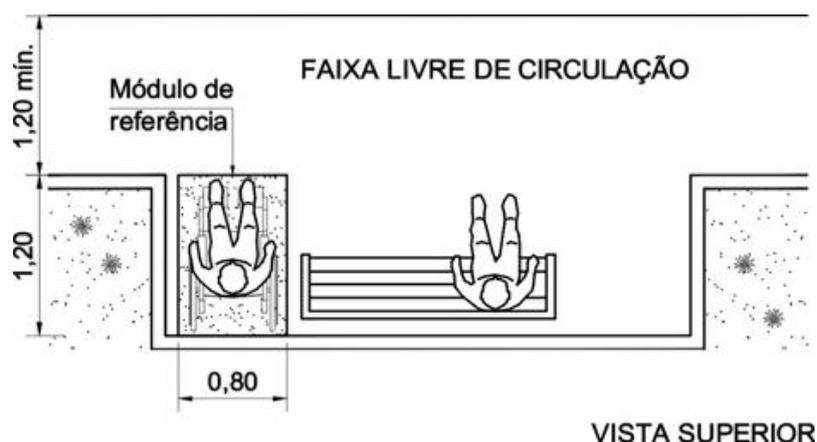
Vista superior de um assento fixo com previsão para pessoa em cadeira de rodas
